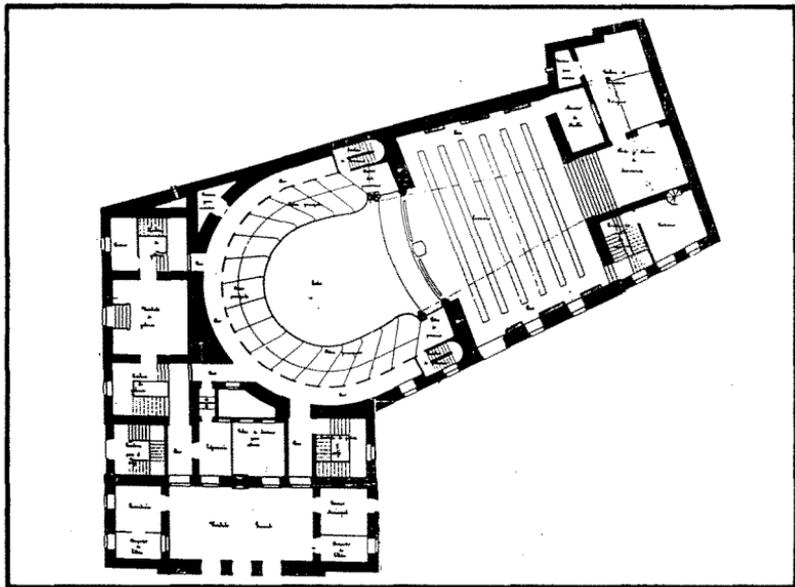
Proyecto de Amador de los Ríos. Planta baja a nivel de palcos de platea, 1870. (A.M.T.).
